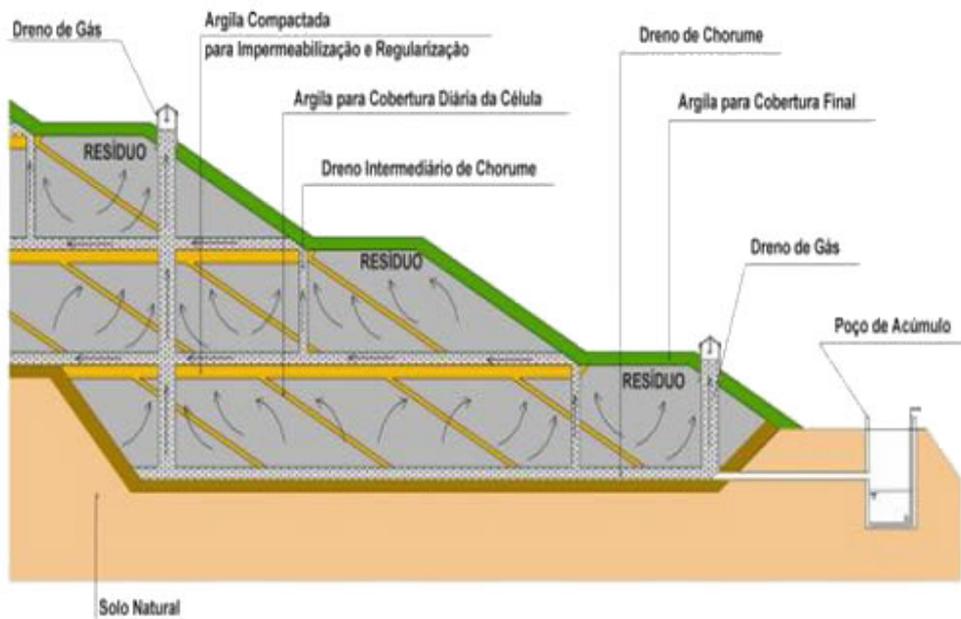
Corte esquemático de uma trincheira construída adequadamente
